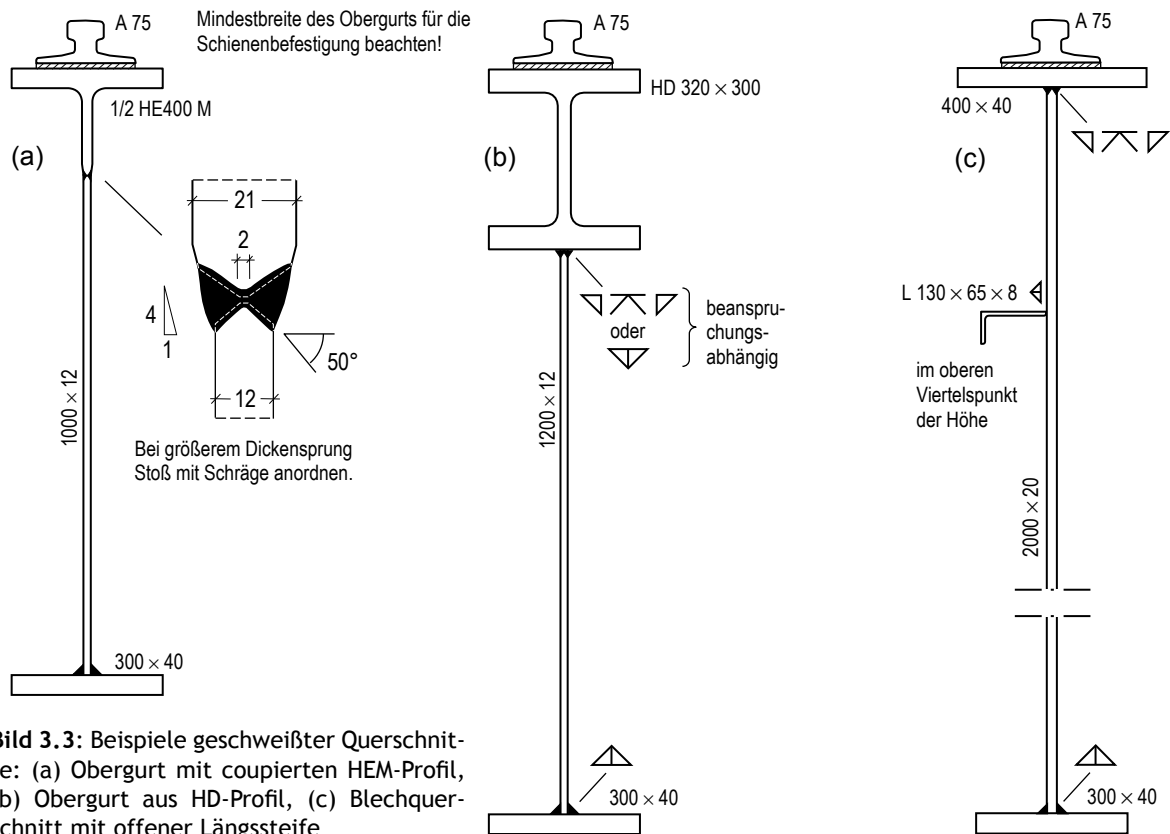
Beispiele geschweißter Querschnitte: (a) Obergurt mit coupierem HEM-Profil, (b) Obergurt aus HD-Profil, (c) Blechquerschnitt mit offener Längssteife
